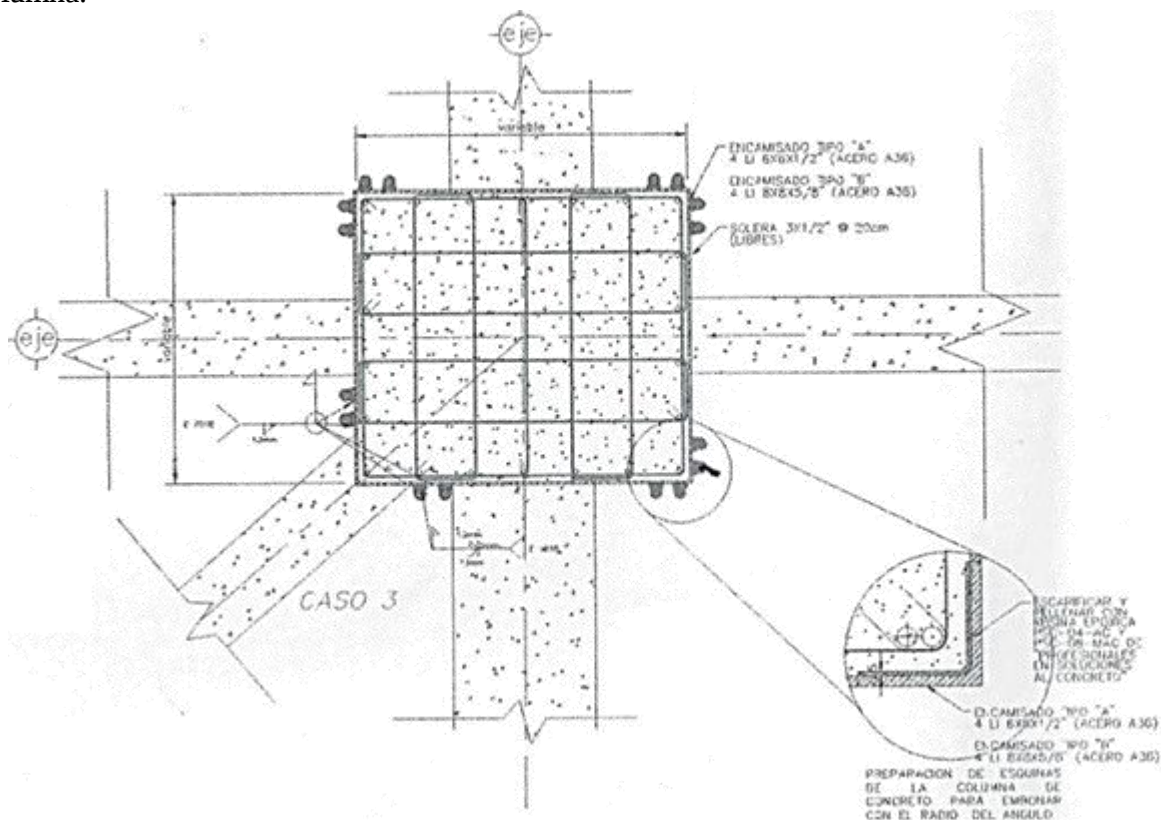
Vista en planta, de la configuración del refuerzo estructural del proyecto Postensa, tomado de los planos estructurales de Gómez González (2020).
